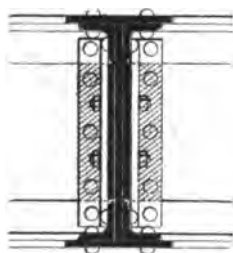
bis. — Assemblage de 2 poutres de même hauteur avec fourrutes.
